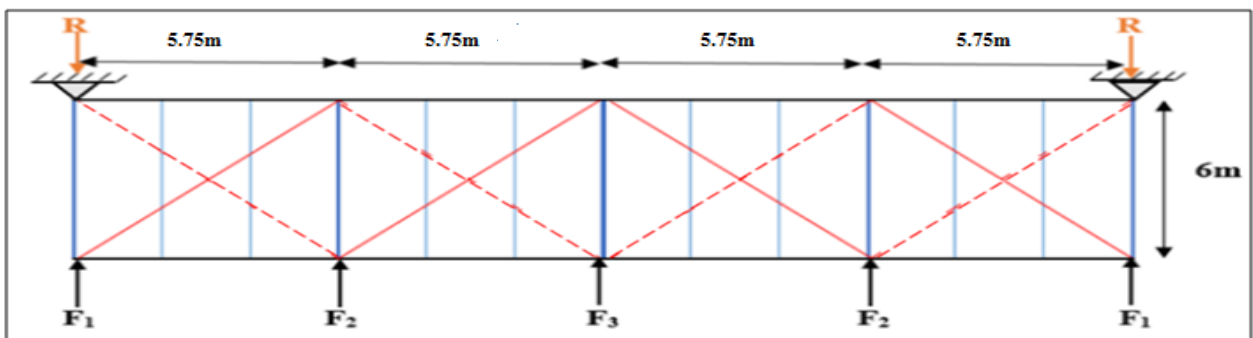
Schéma statique de la poutre au vent (effet de traction).
